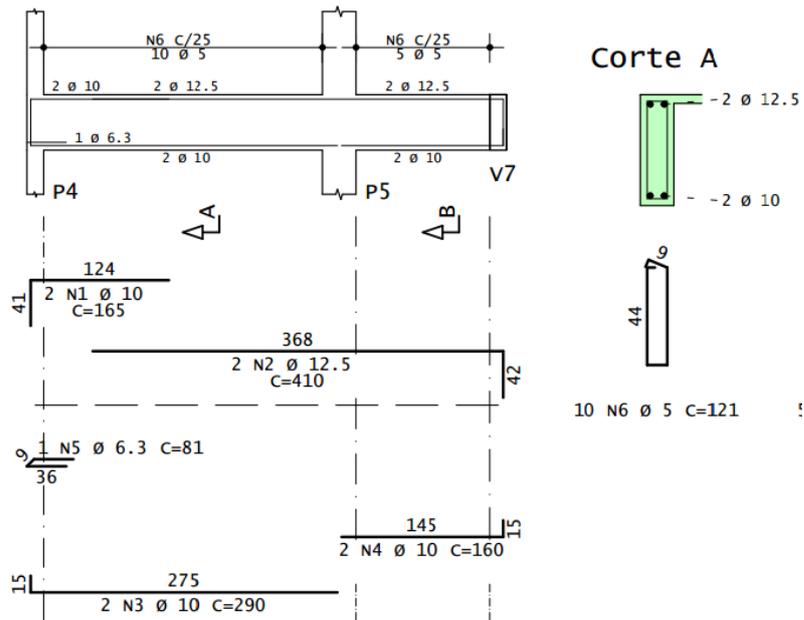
Armadura da viga V3 – pavimento superior (nível +3,00)
